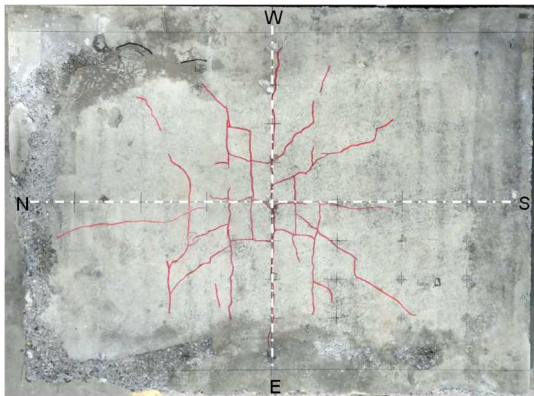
下面のひび割れ状況 (供試体 CF)
